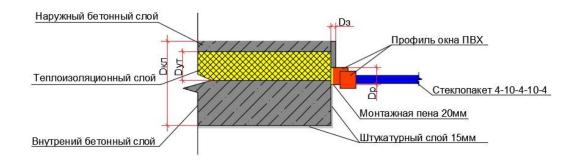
Расчетная схема для ELCUT 6.0 (Крупнопанельная стена)
